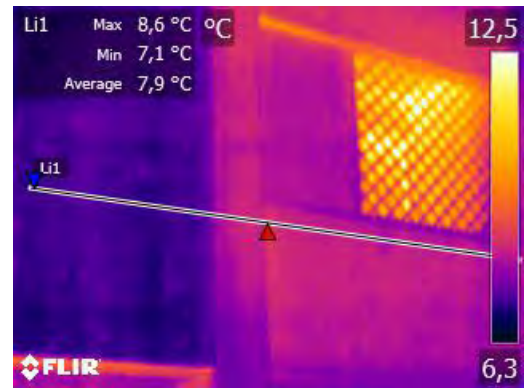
CA\_12: condizione di rilevazione passiva, fascia oraria 8-9. Prospetto est e sud.
